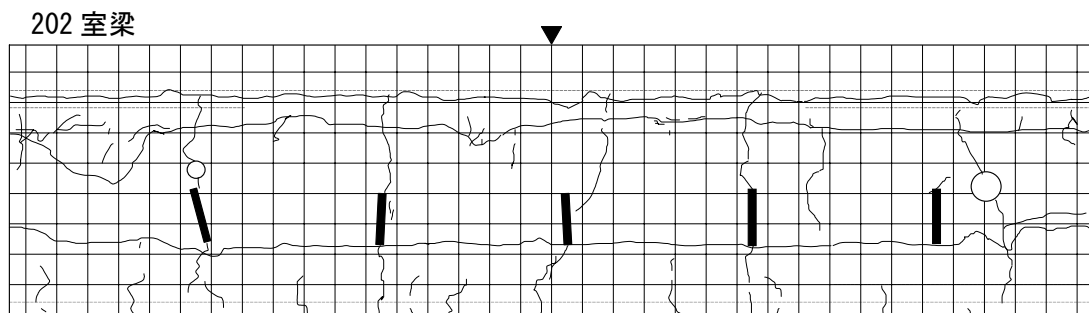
加力前のひび割れ状況 (202 室梁)
